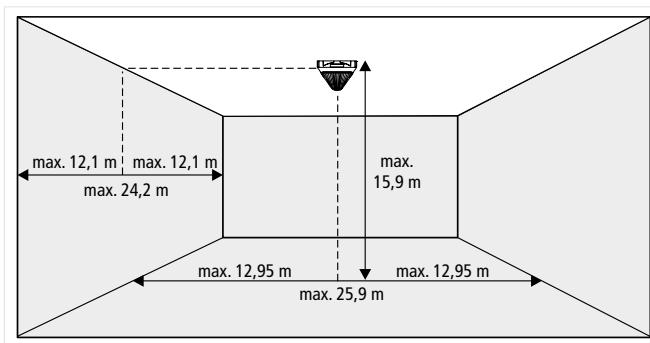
Projektierung Decke mit Lichtfarbe weiß
